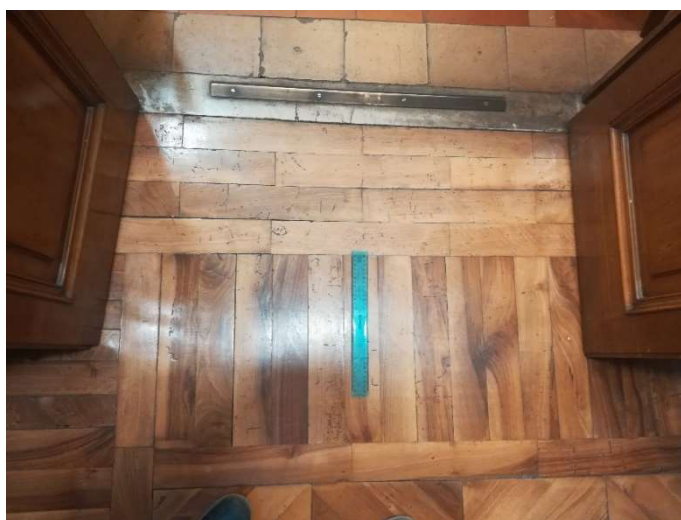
vista del parquet fascia perimetrale pavimentazione Camera di Consiglio
